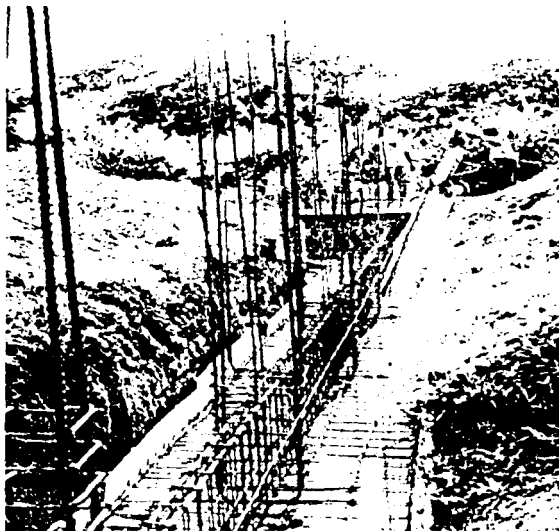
Habilitado y armado acero de refuerzo en cimentación
